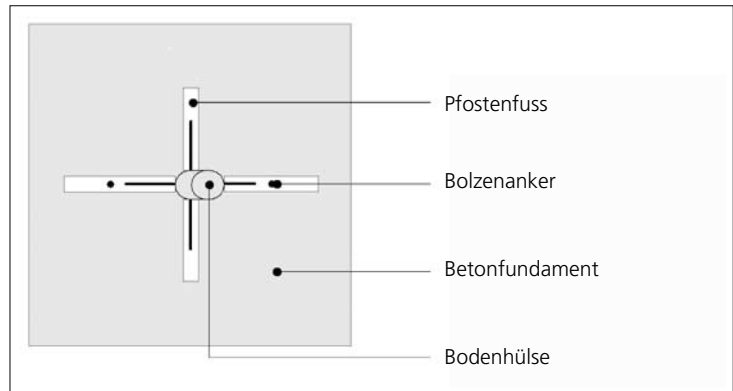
Grundriss; mobile Boden­hülse auf Betonfundament
